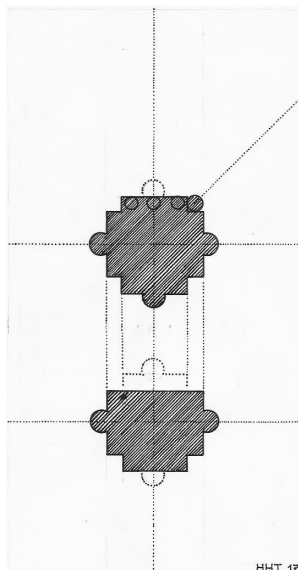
Riddagshausen, Aufbauschema des südwestlichen Vierungspfeilers
